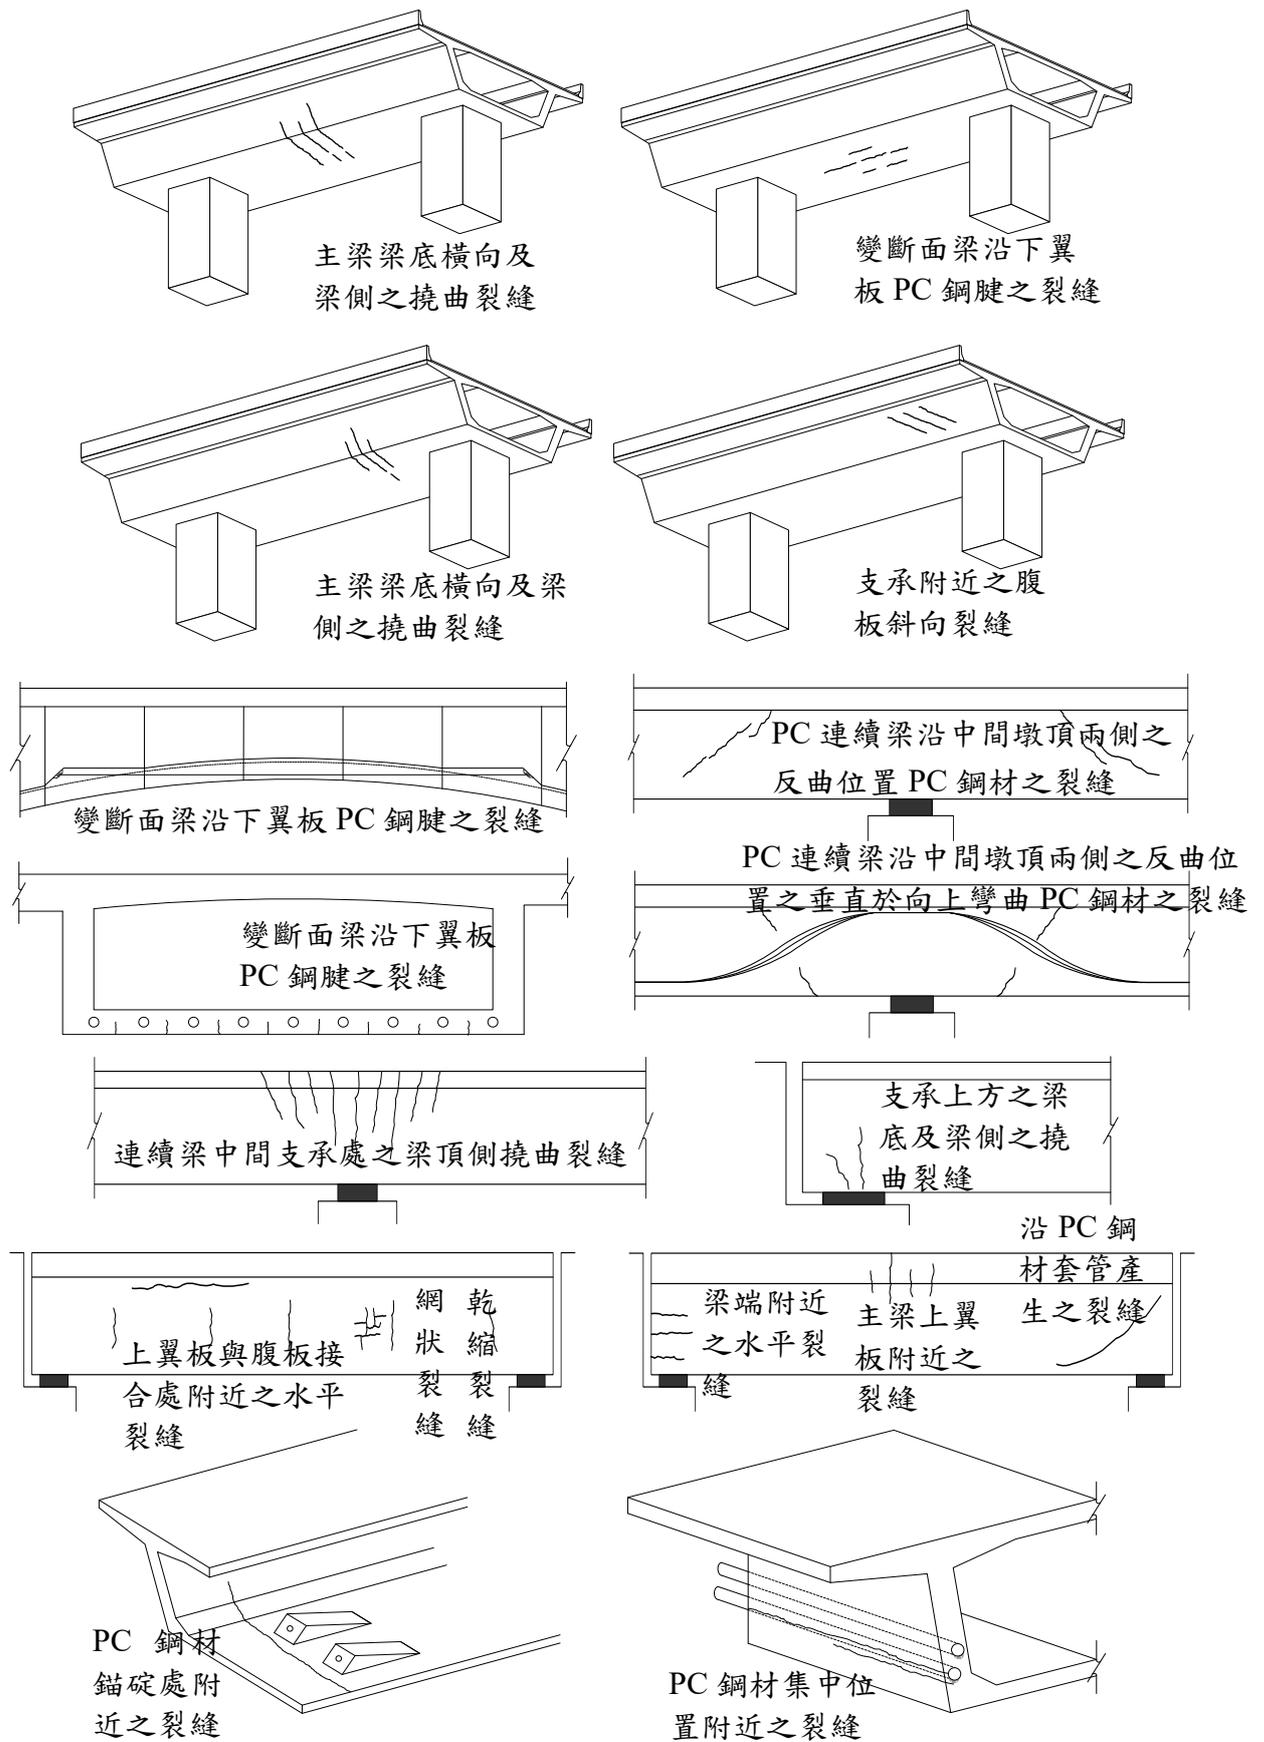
預力混凝土箱型梁裂縫示意圖
